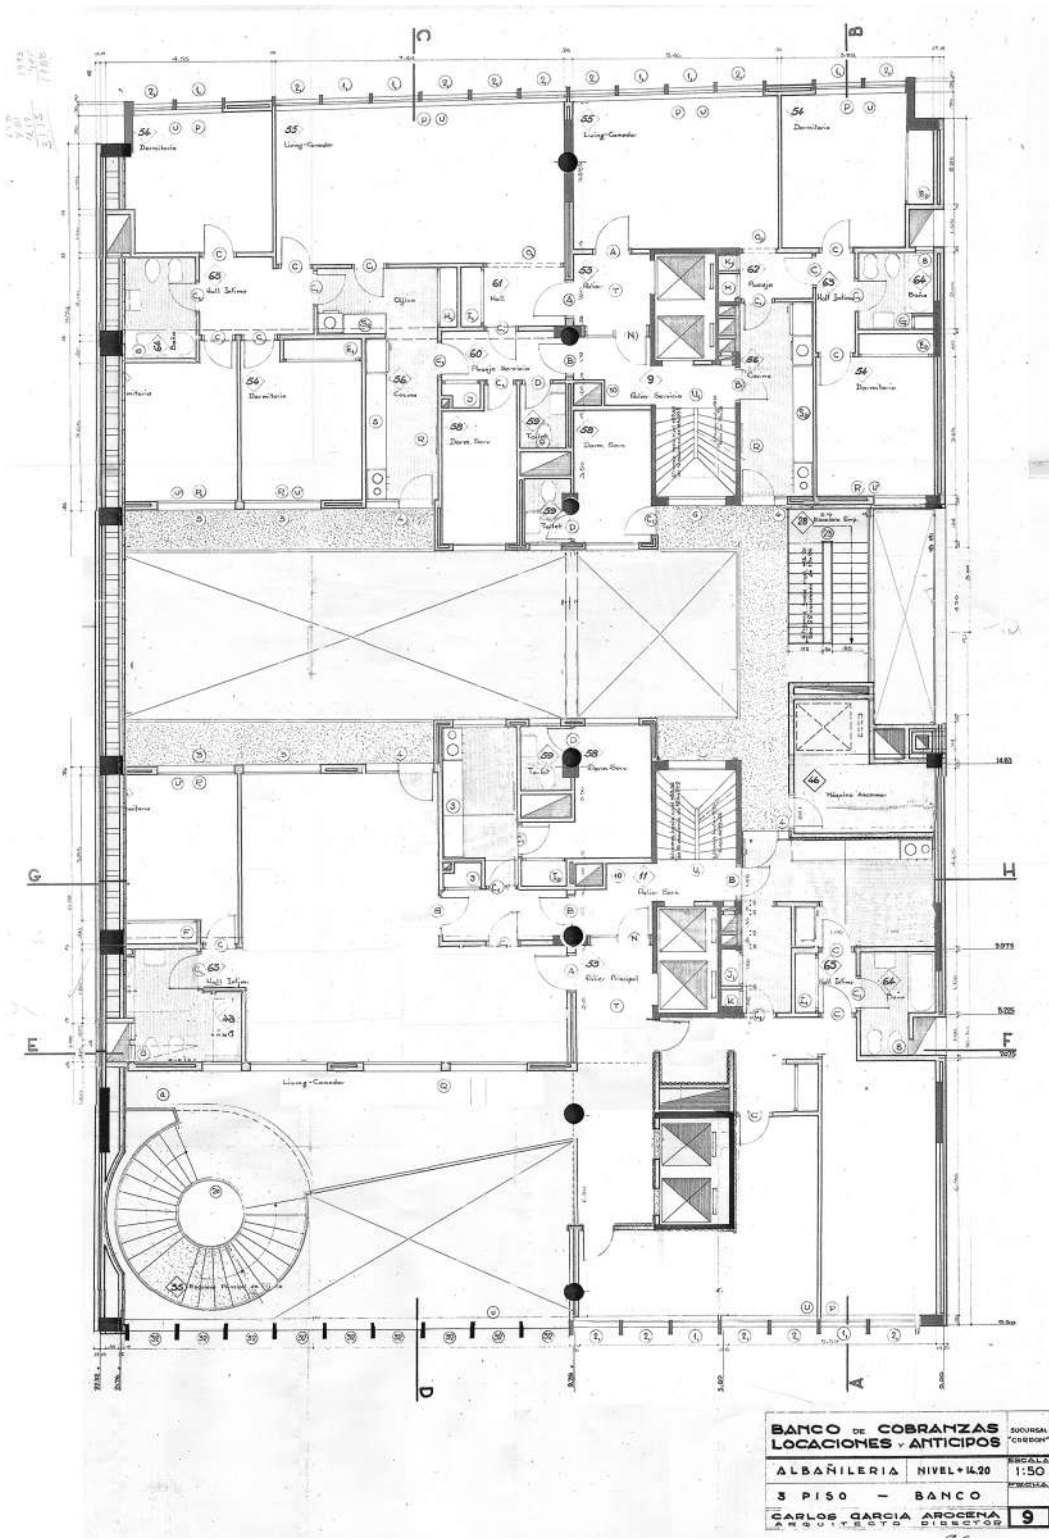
Planta alterada del piso tres del BCLA para utilizarse como viviendas
